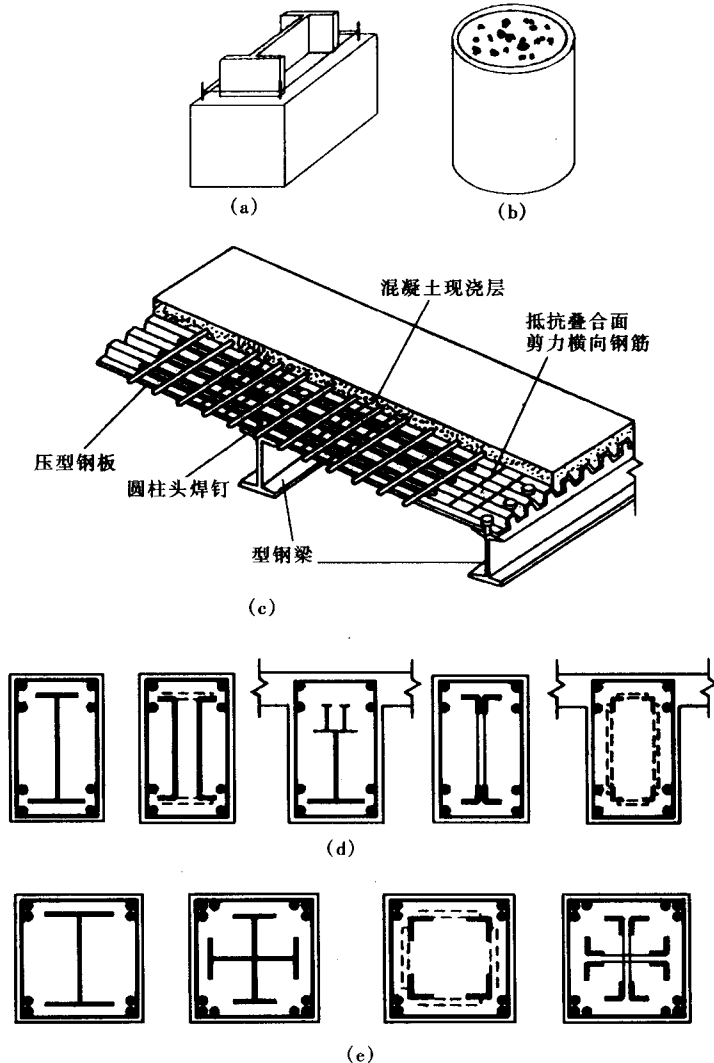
几种特殊形式的钢筋混凝土结构构件示意图
